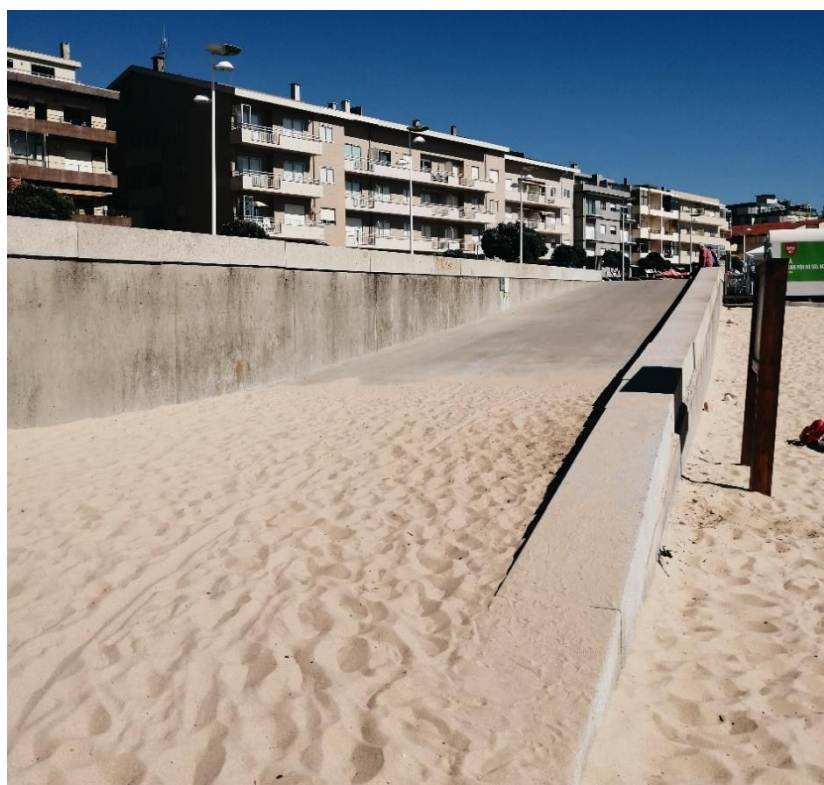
| Laje sem muro com apoios em colunas de JET GROUTING, 2006
